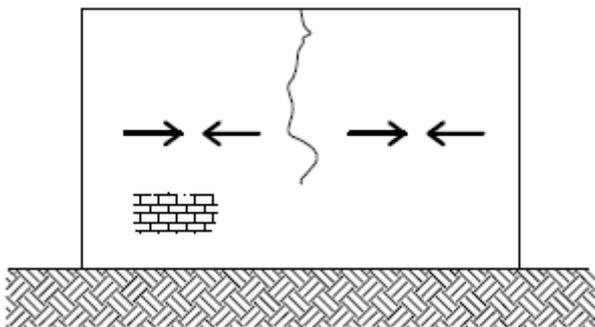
Fissura vertical por vinculação dos elementos
